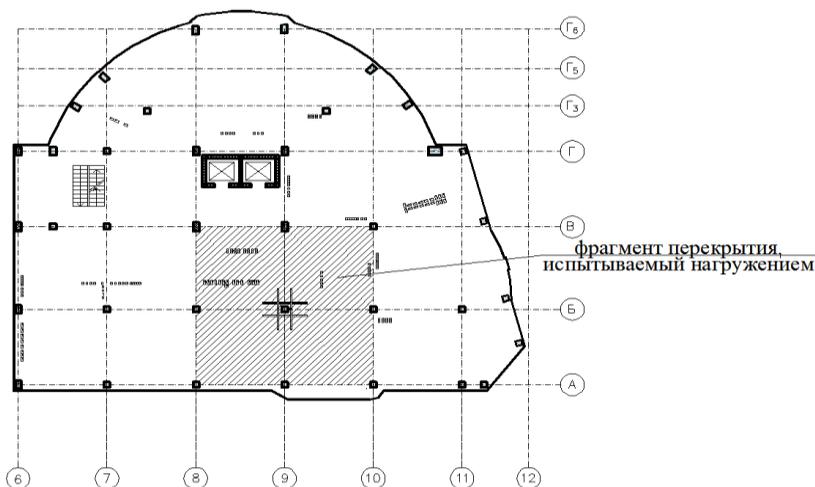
Фрагмент перекрытия, испытываемого нагружением
